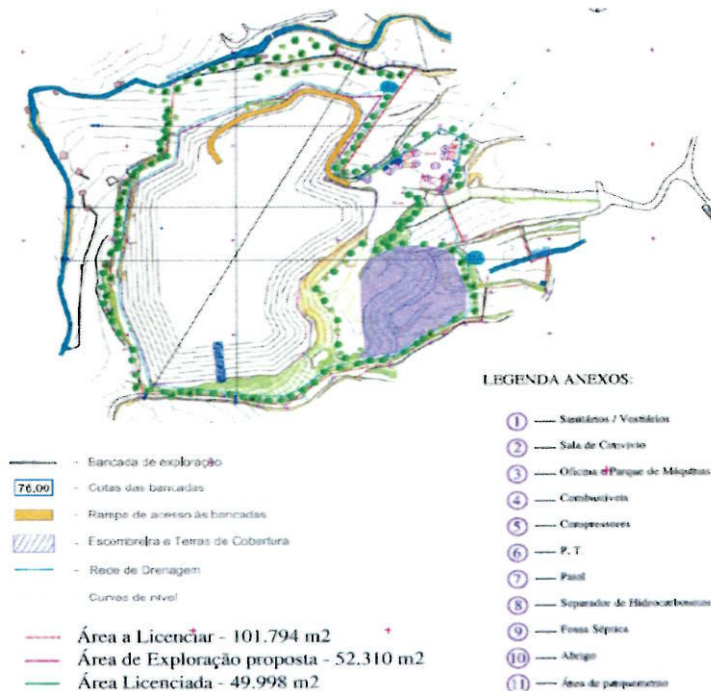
Planta final de exploração (Fonte: EIA – outubro de 2016).
